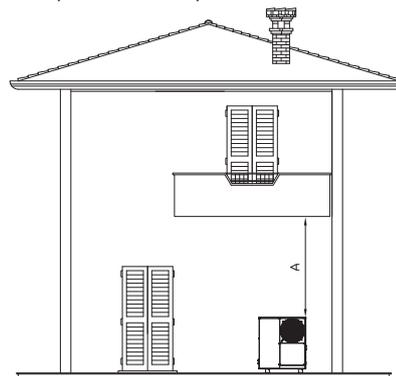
Distanze minime di rispetto K18 Simplygas
